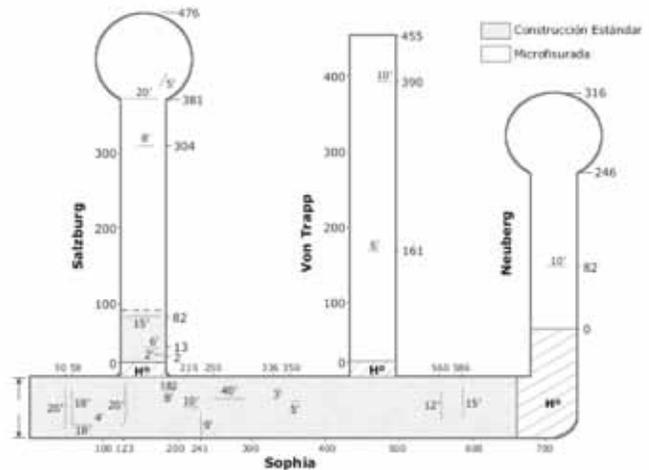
Evaluación del estado del pavimento a los 6 meses. Fisuras transversales menores en tramo.
